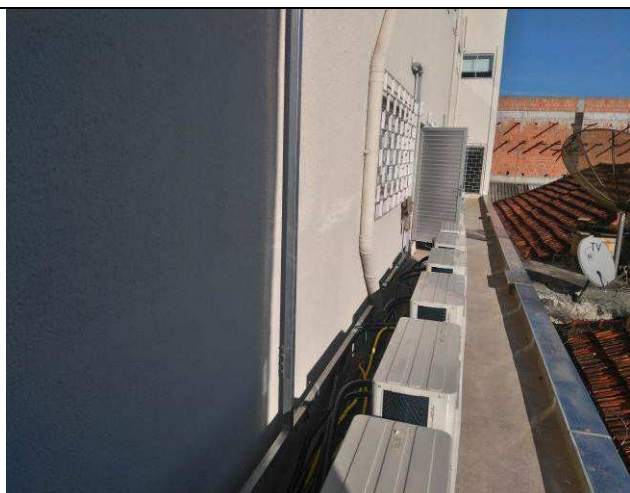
E: Infraestrutura perfilados - alimentação condensadoras 1º pavimento.
